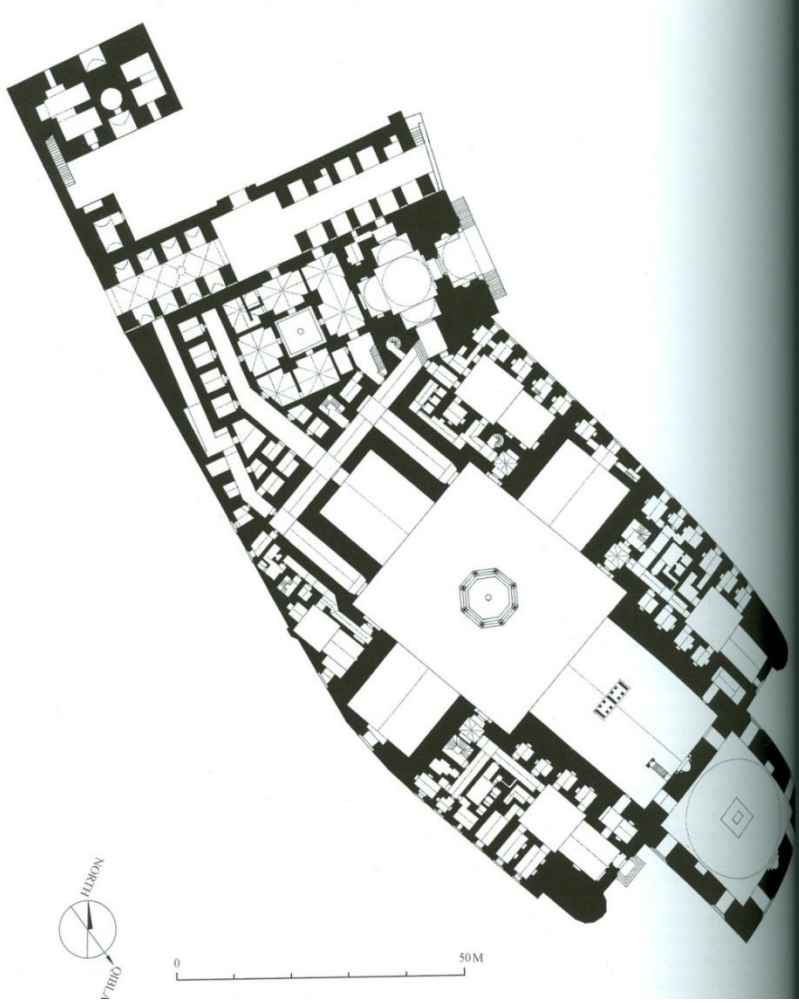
مسقط أفقي لجامع برسبای بالخانكة. عمل الباحث
